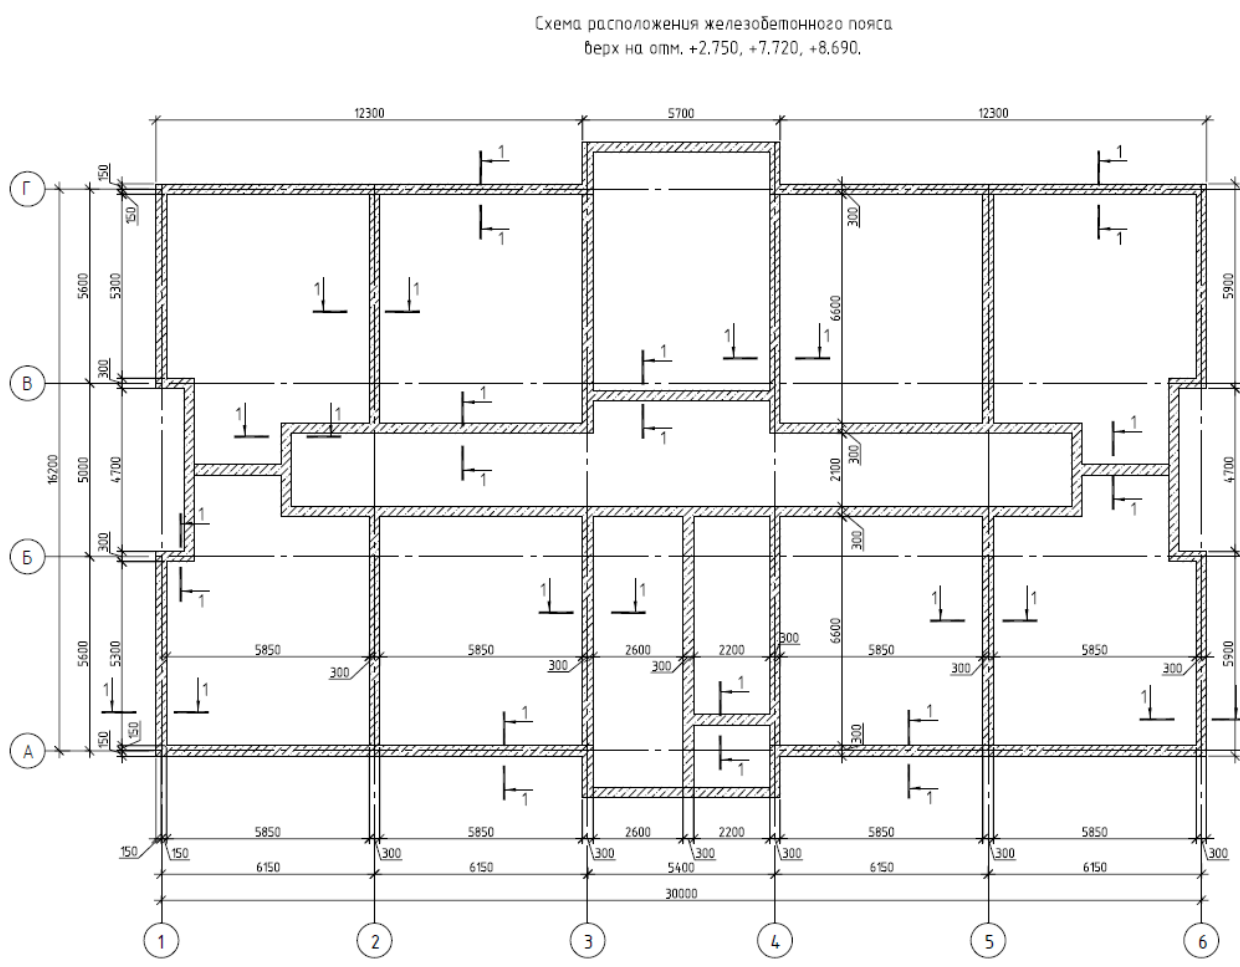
Обследование железобетонного пояса отм. верха +2.750, +7.720, +8.690
